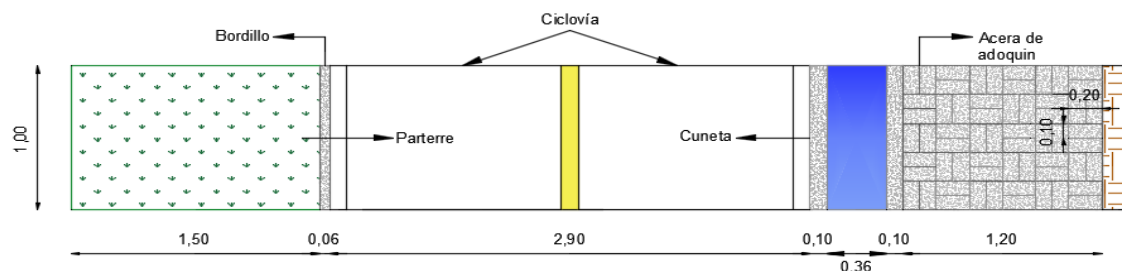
Vista en planta acera ciclovía segregada Parque de la Armenia
